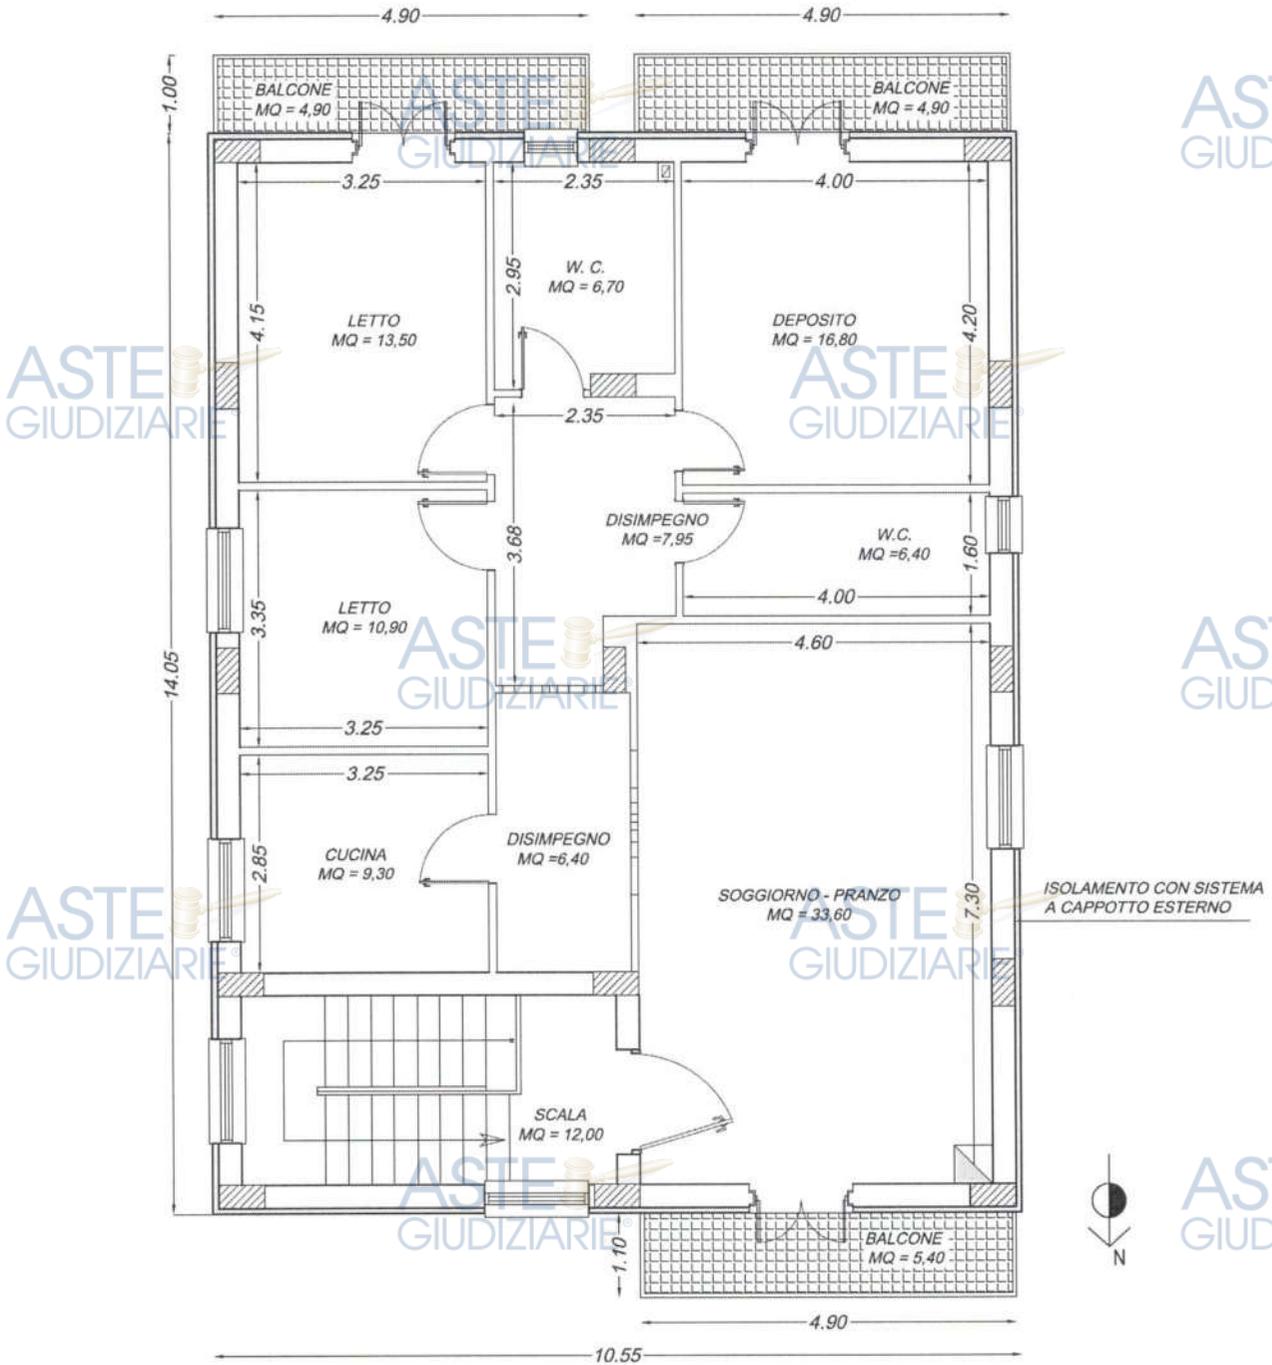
Planimetria Stato di Fatto Foglio 23, p.lla 371, sub 4 - Piano Primo
